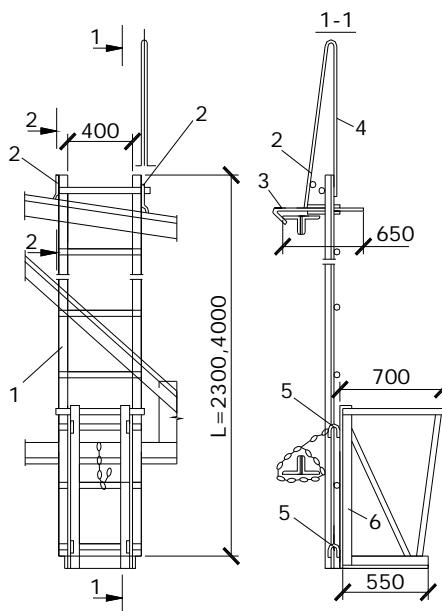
Лестница с люлькой для навески на металлическую ферму:
